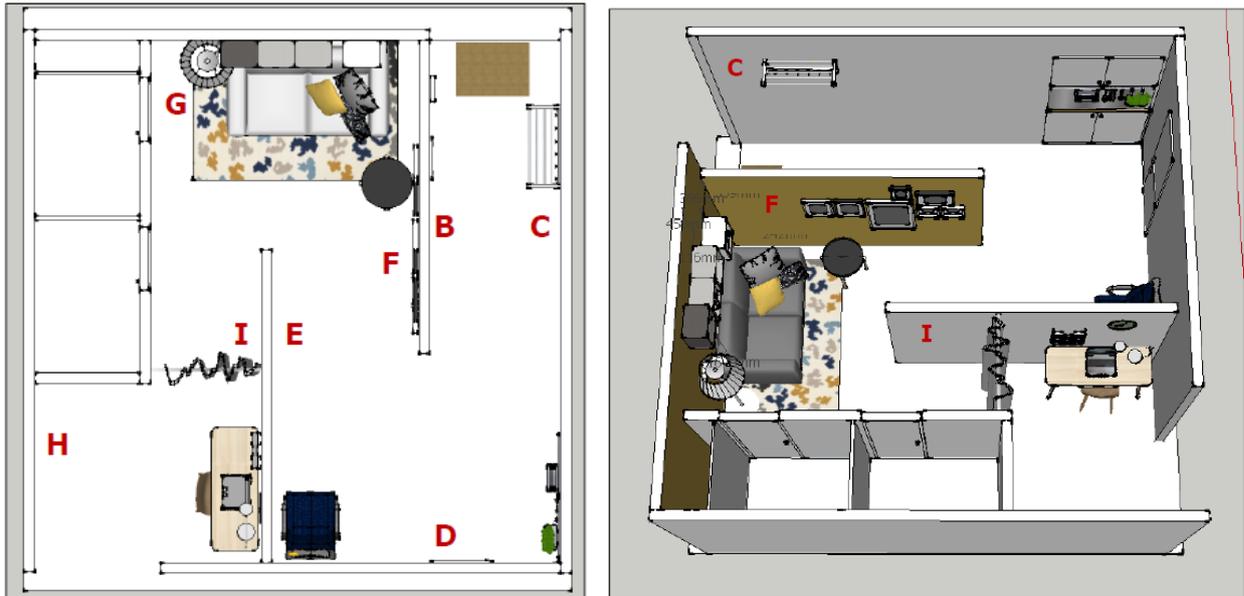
Grundriss und Seitenansicht der Ausstellung #misläbe
